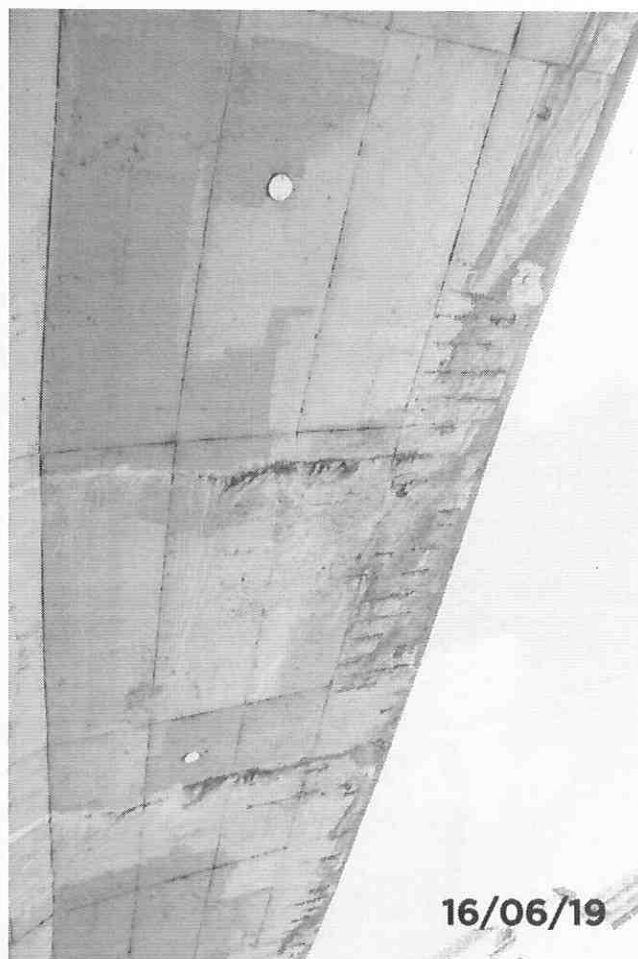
Vista geral frontal inferior da Passarela, detalhe de ausência de pingadeira laterais, processo de infiltração e armaduras expostas
